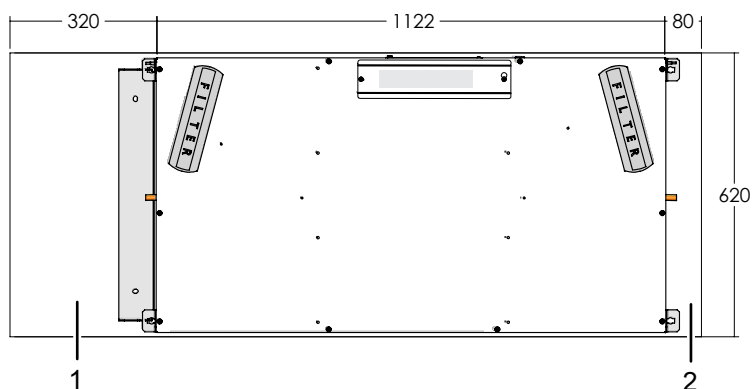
espace nécessaire en cas de montage au plafond en mode A
